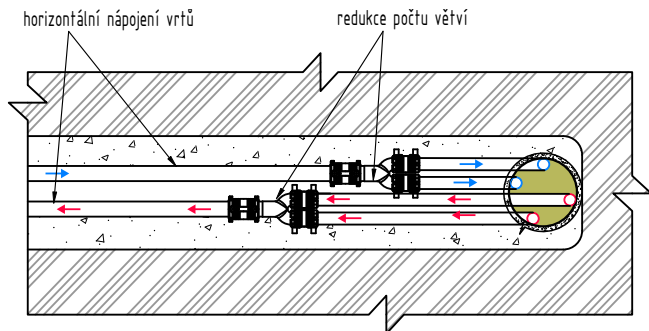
DETAIL VRATNÉHO U - KOLENA SE SEPARAČNÍ JÍMKOU M 1:50
